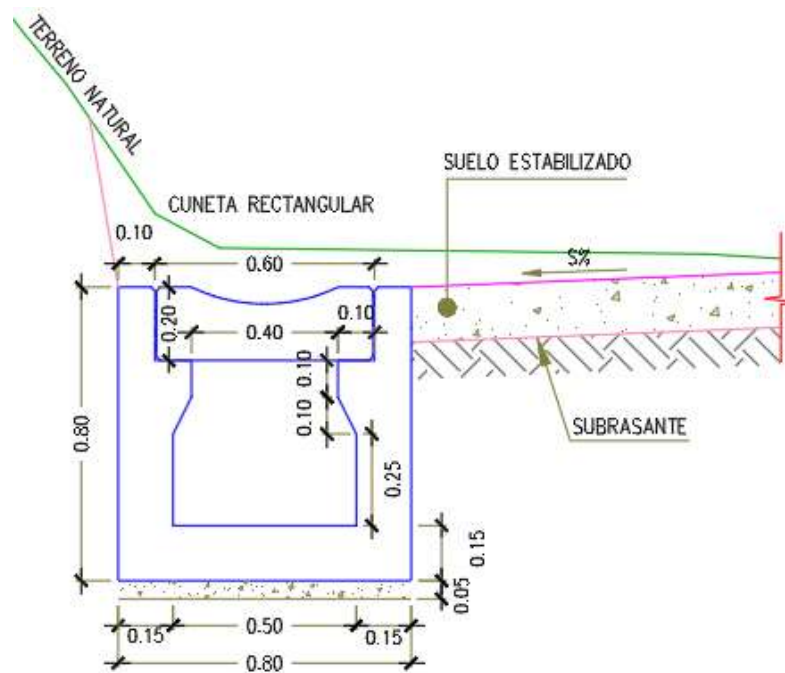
Sección típica de cuneta rectangular de concreto armado Tipo III. Fuente: Informe de Hidrología e Hidráulica.
